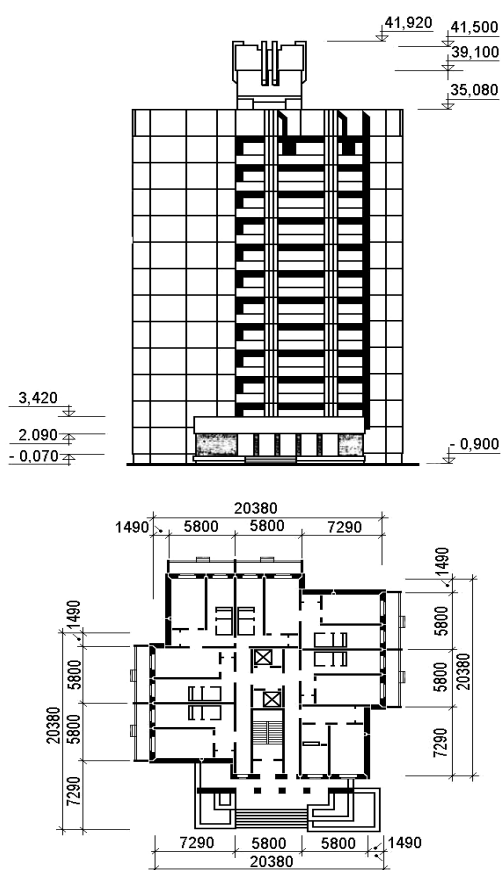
БелНИИГрадостроительства (Новополоцк). 1979 г. 12-этажный 83-квартирный крупнопанельный жилой дом для малосемейных. Схемы фасада и плана 1 этажа
